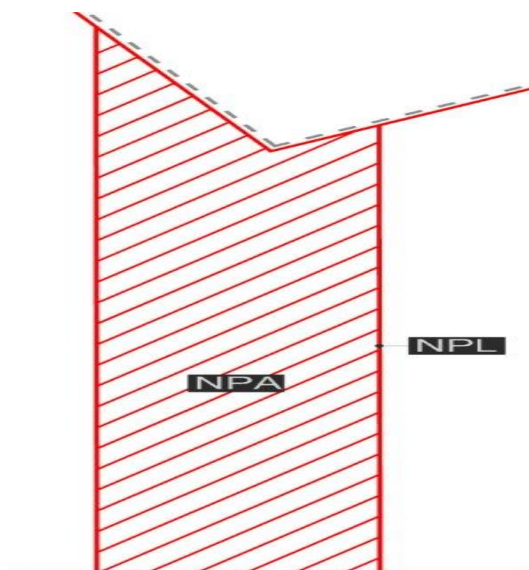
Stralcio segnaletica dell'Area di Divieto di Sosta (NPL - NPA)
